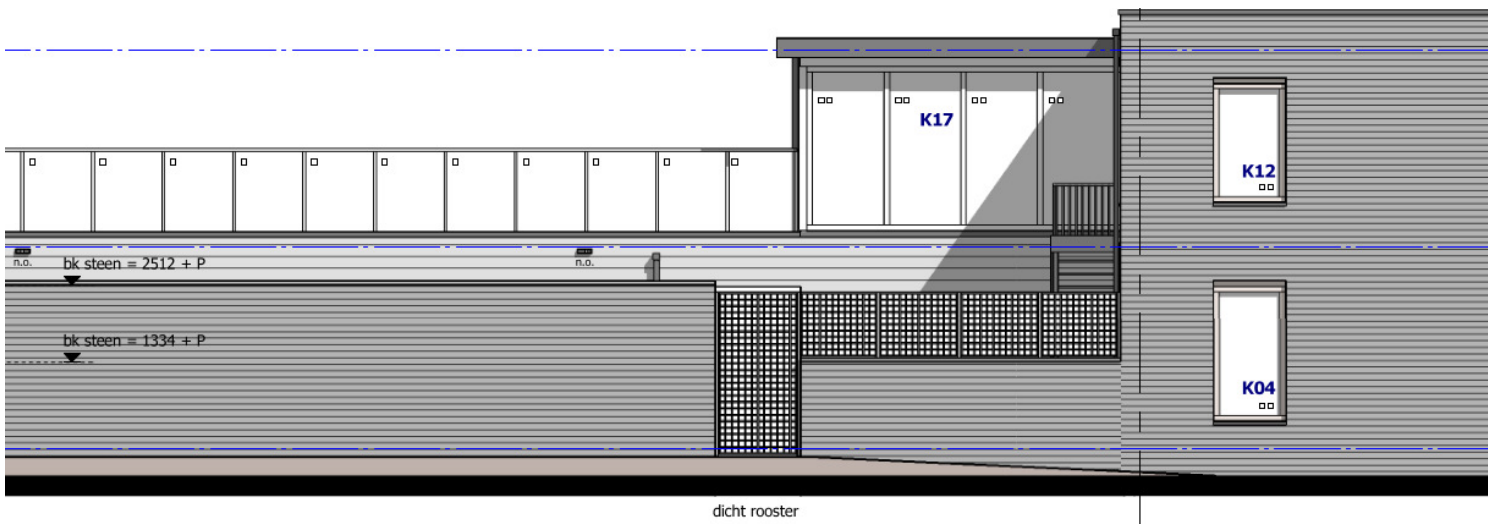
Zuidzijde appartementen: Detail: Erfafscheiding bij toegang naar hoofdingang:
